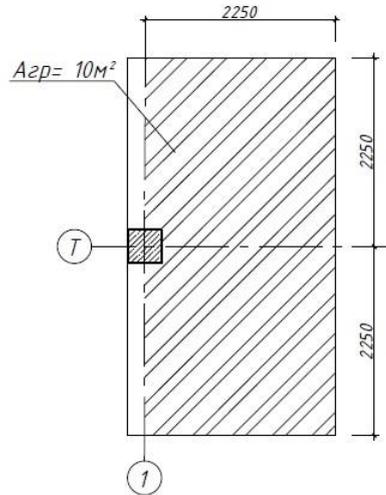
Грузовая площадь средней-сжатой колонны по осям Т–1.
